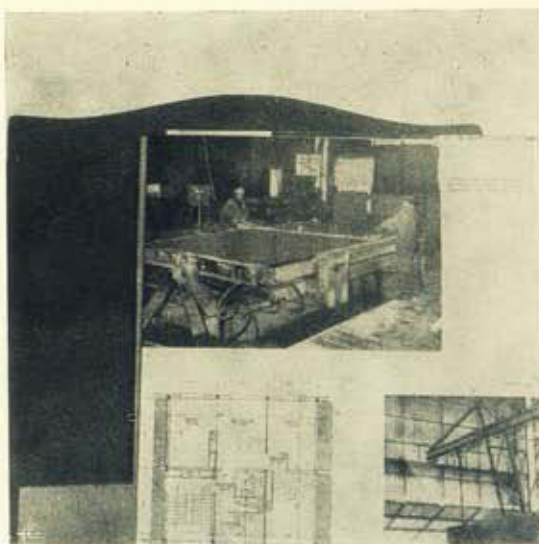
Vibração do betão num elemento vazio após a fundição. Em baixo planta das habitações construídas em Rouen, segundo o plano Lopoia. O bloco tem 8,90 m de largura e os módulos das dependências são de 3,05 m.
